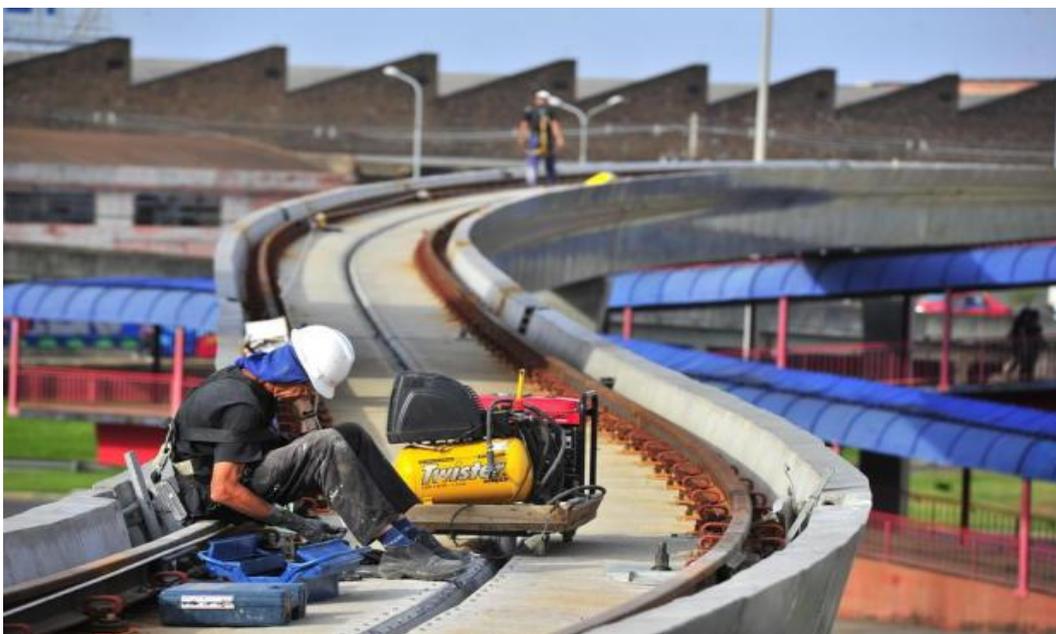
Detalhe da fixação dos trilhos à via elevada (Coester,2013).
